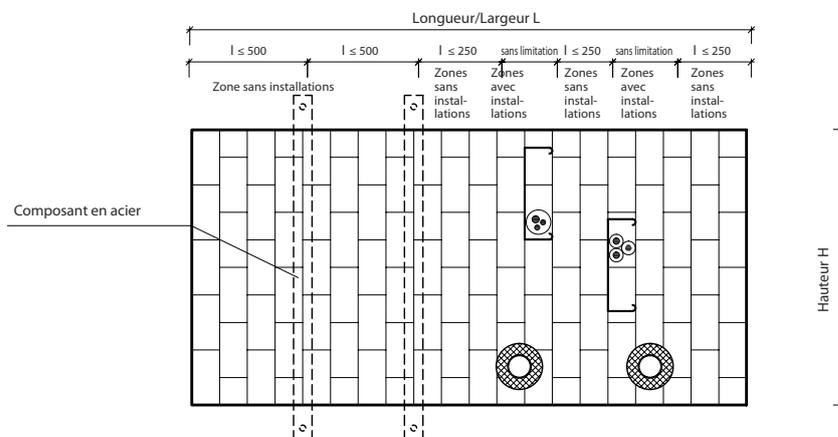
Support des zones de calfeutrement de 200 mm d'épaisseur dans les plafonds
